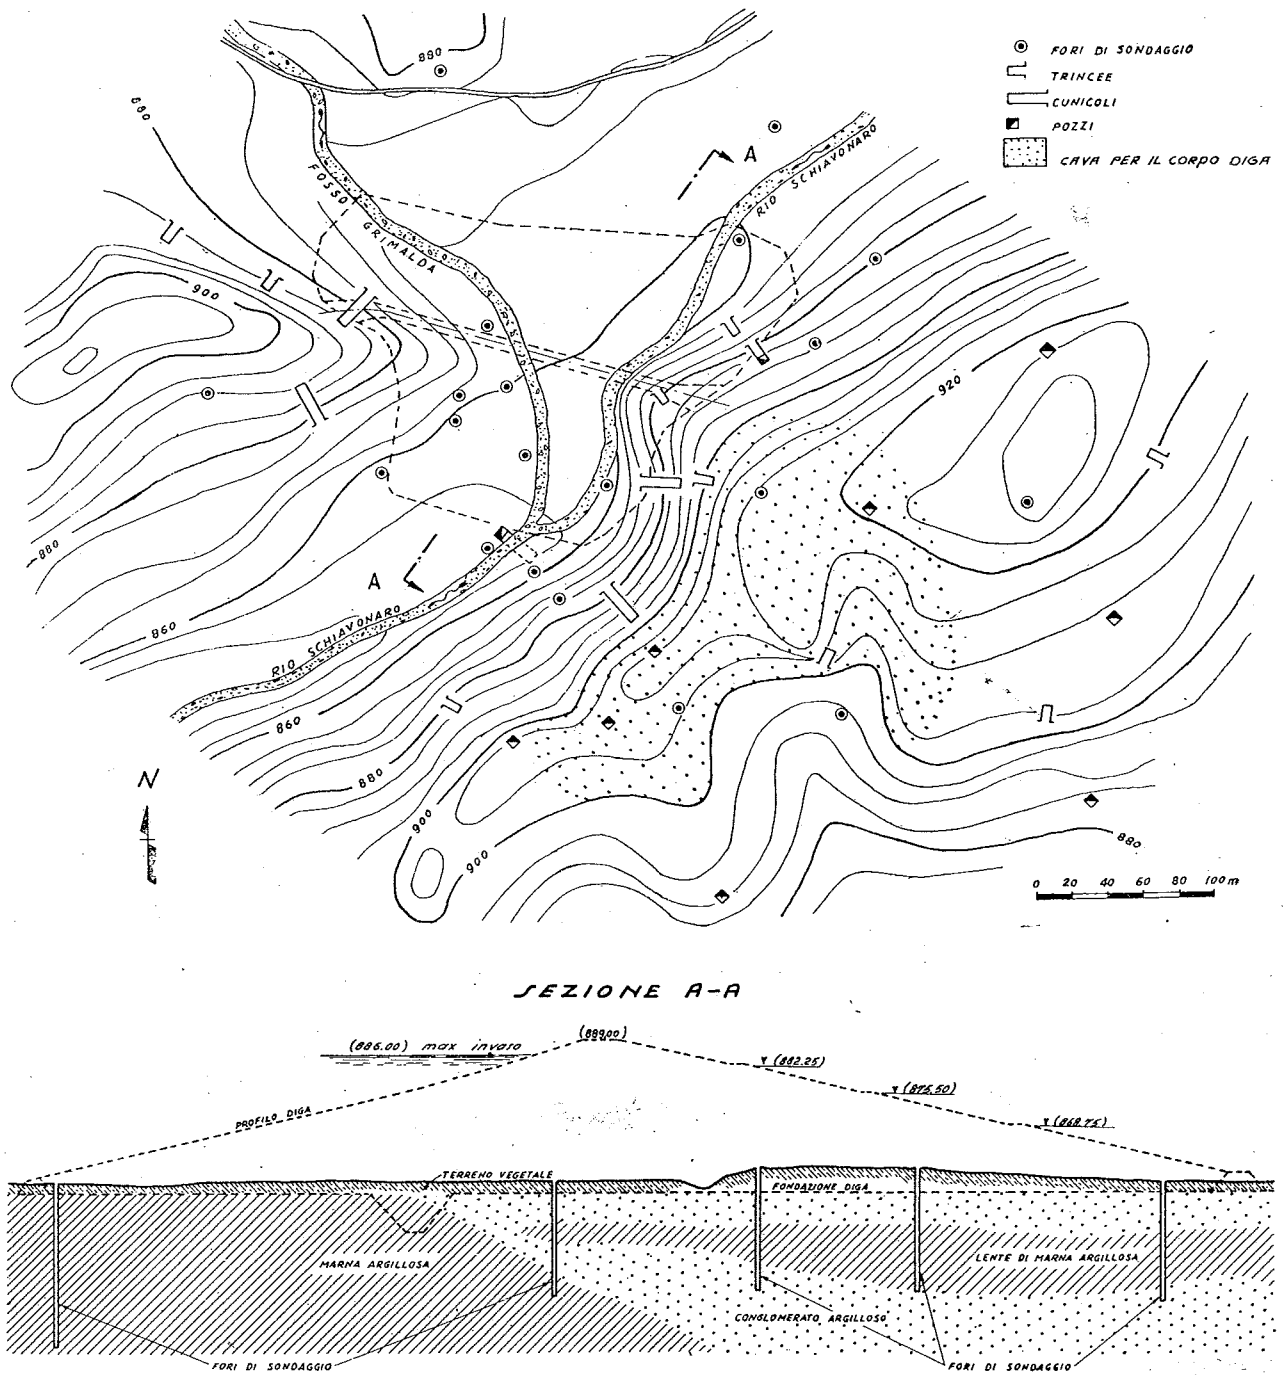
a) Planimetria dei sondaggi e scavi di esplorazione; b) Sezione stratigrafica dei terreni di fondazione.
